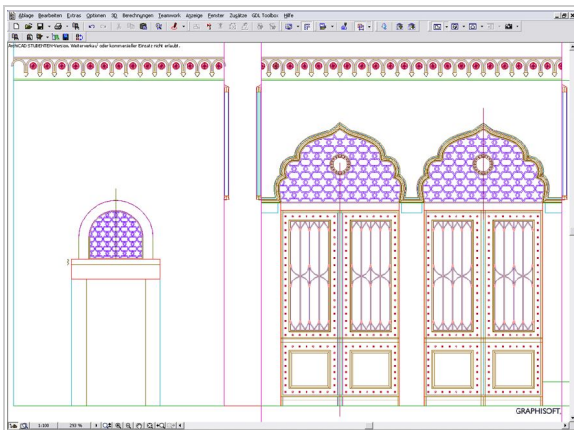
Teil der Montage des Gassenportals im Grundriss.
